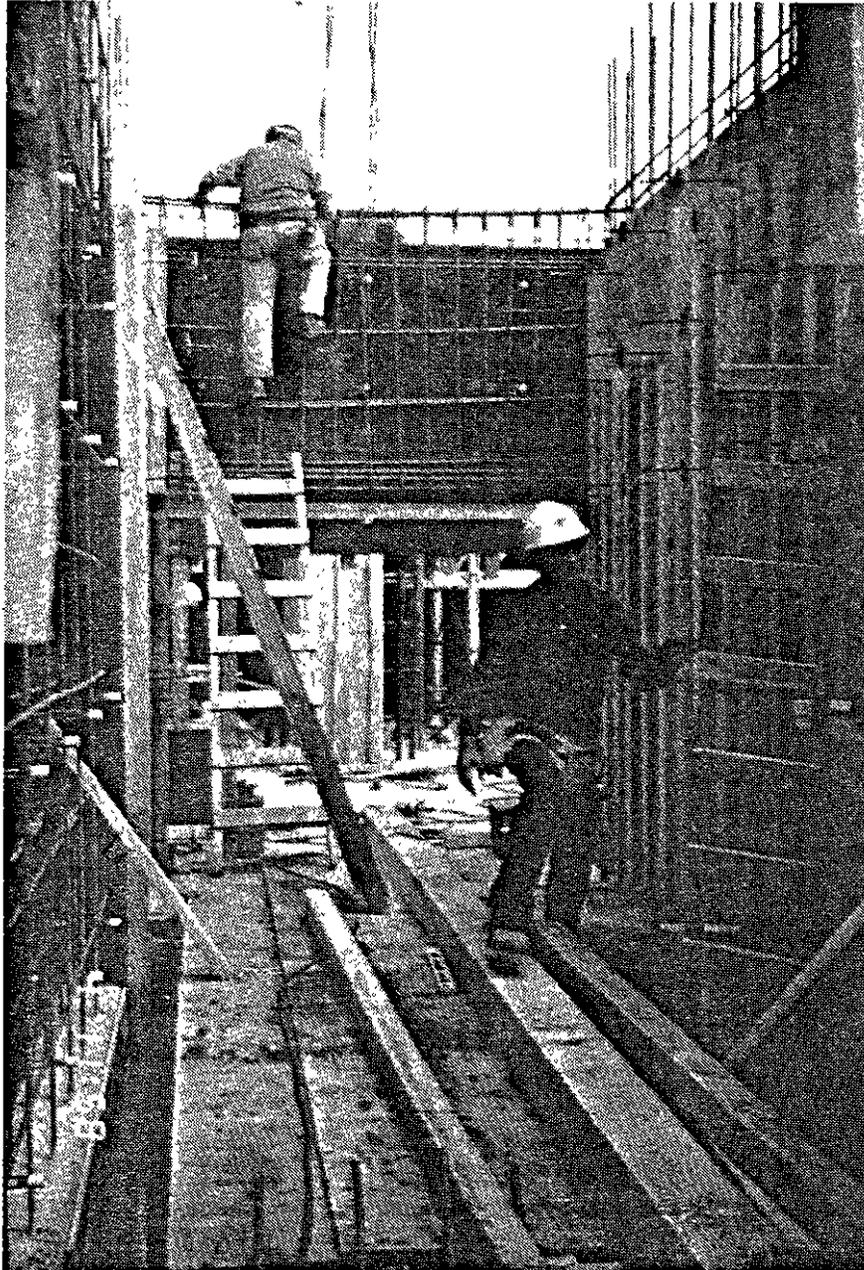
PRÉSENCE D'UN MURET AU CENTRE DE LA CAGE D'ESCALIER,
